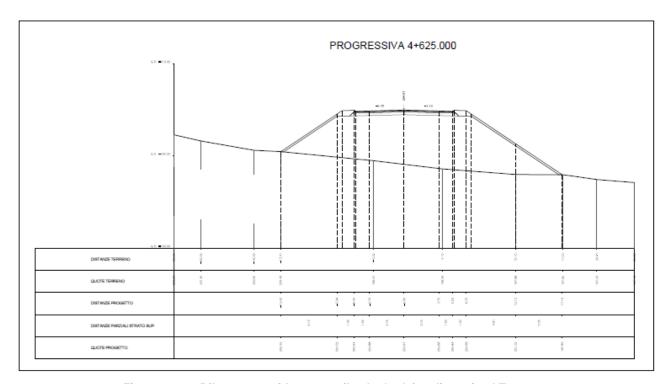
Rilevato considerato per il calcolo dei cedimenti nel Tratto 2
